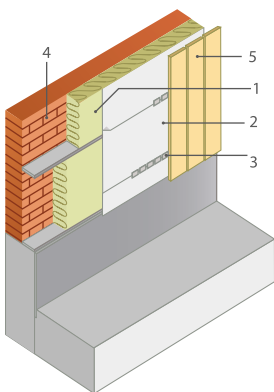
Устройство вентилируемой воздушной прослойки в стенах с обшивкой сайдингом:
